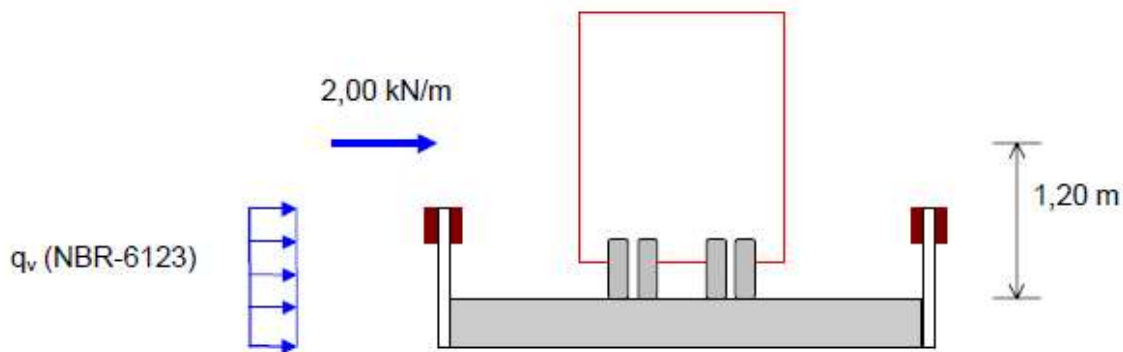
Vento sobre veículo (Fonte: Manual de projeto e construção de pontes de madeira – LaMEM)
